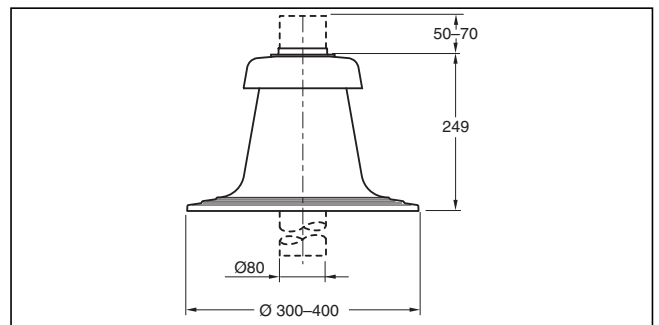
Schachtabdeckung für 80 mm (Maße in mm)
